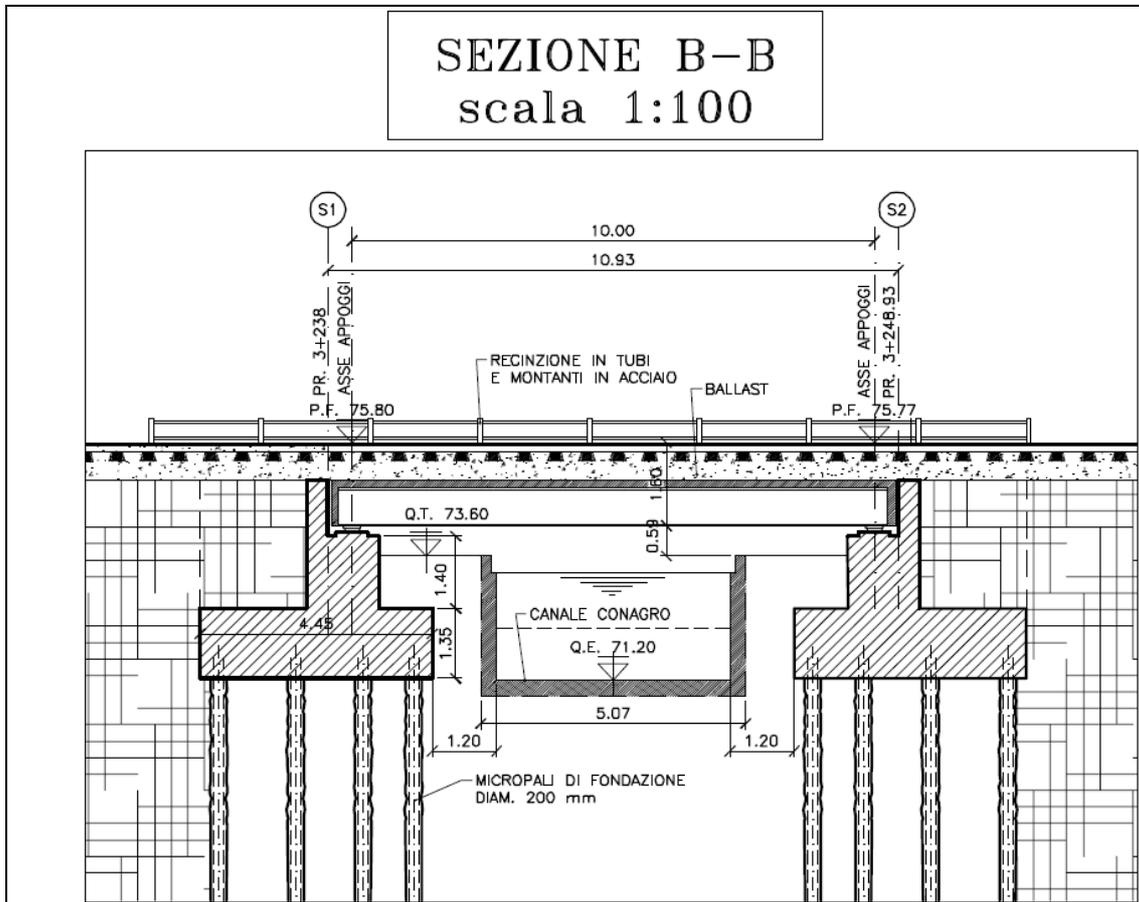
Ponte Canale sul San Giovanni Sezione B-B
